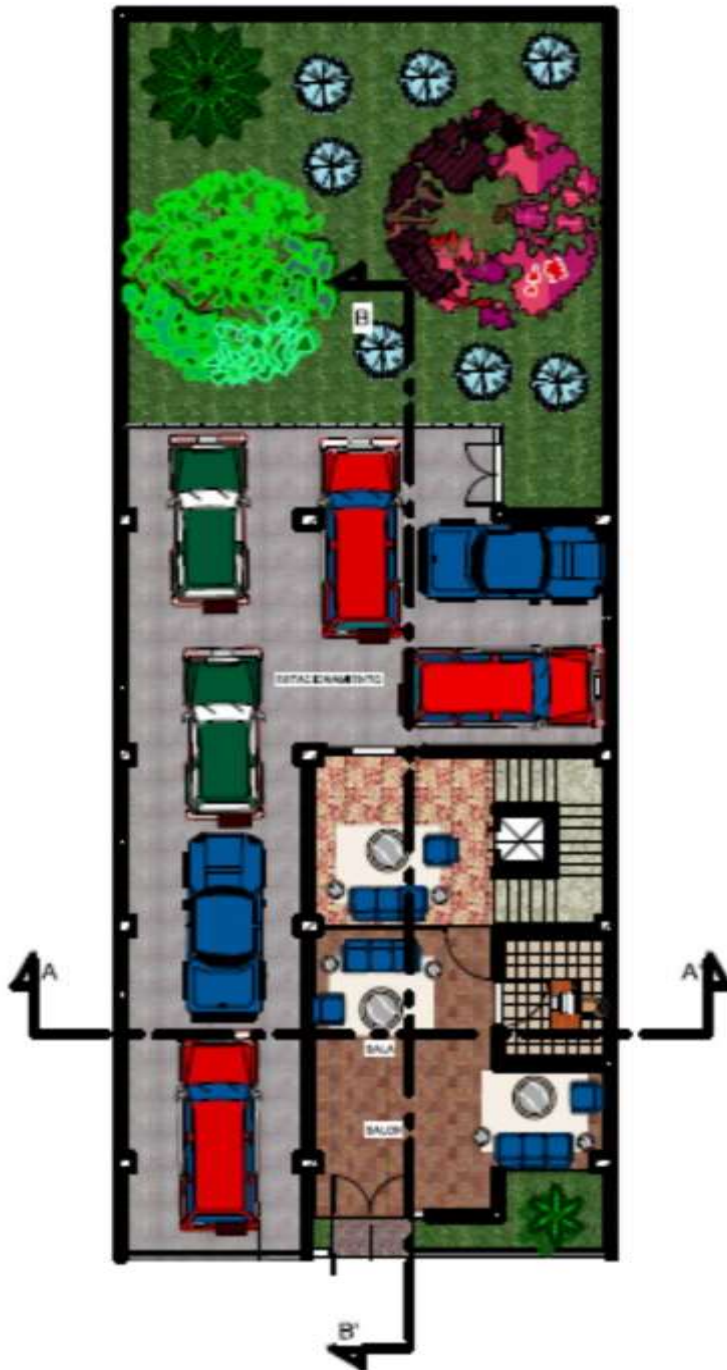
(Vista en planta del edificio objeto del estudio – planta baja)
